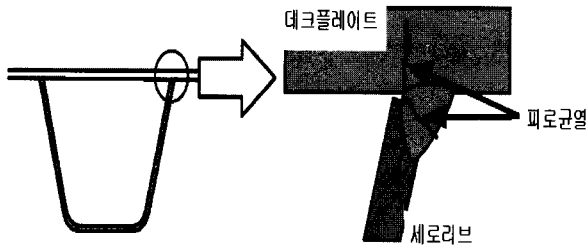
Weld crack of longitudinal rib and deck plate
